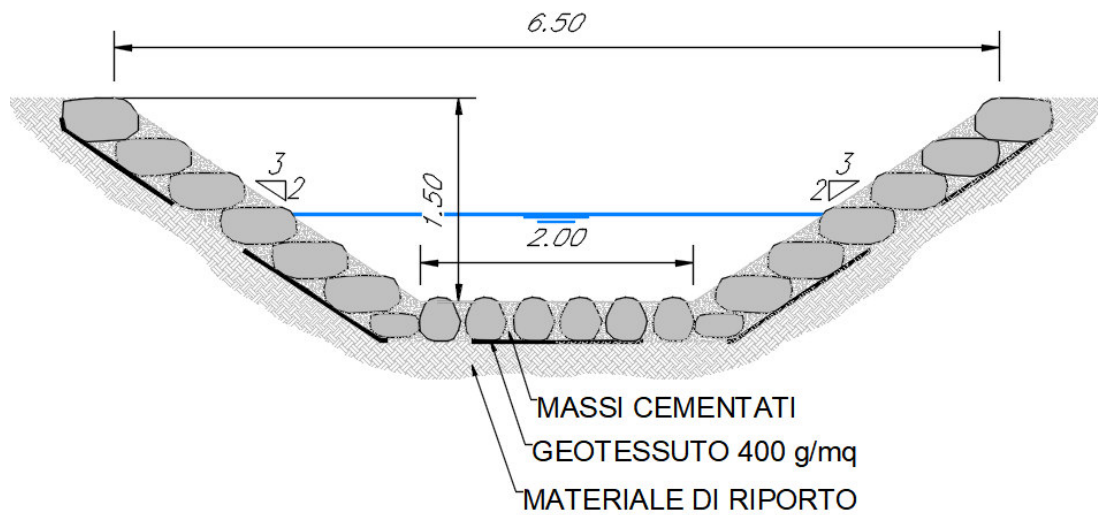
Corso d'acqua IN06_Sezione tipo sistemazione
